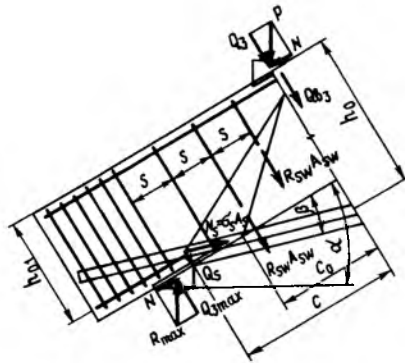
Схема расчетных усилий в наклонном сечении балок с наклонной растянутой гранью при наклонном положении балки
